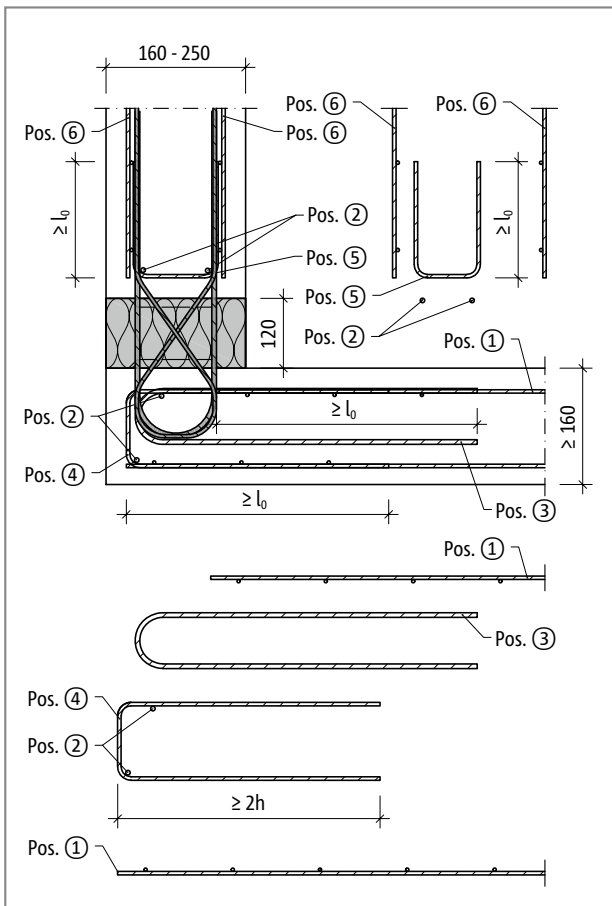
Schöck Isokorb® XT Typ AP vertikale Anordnung: Bauseitige Armierung
